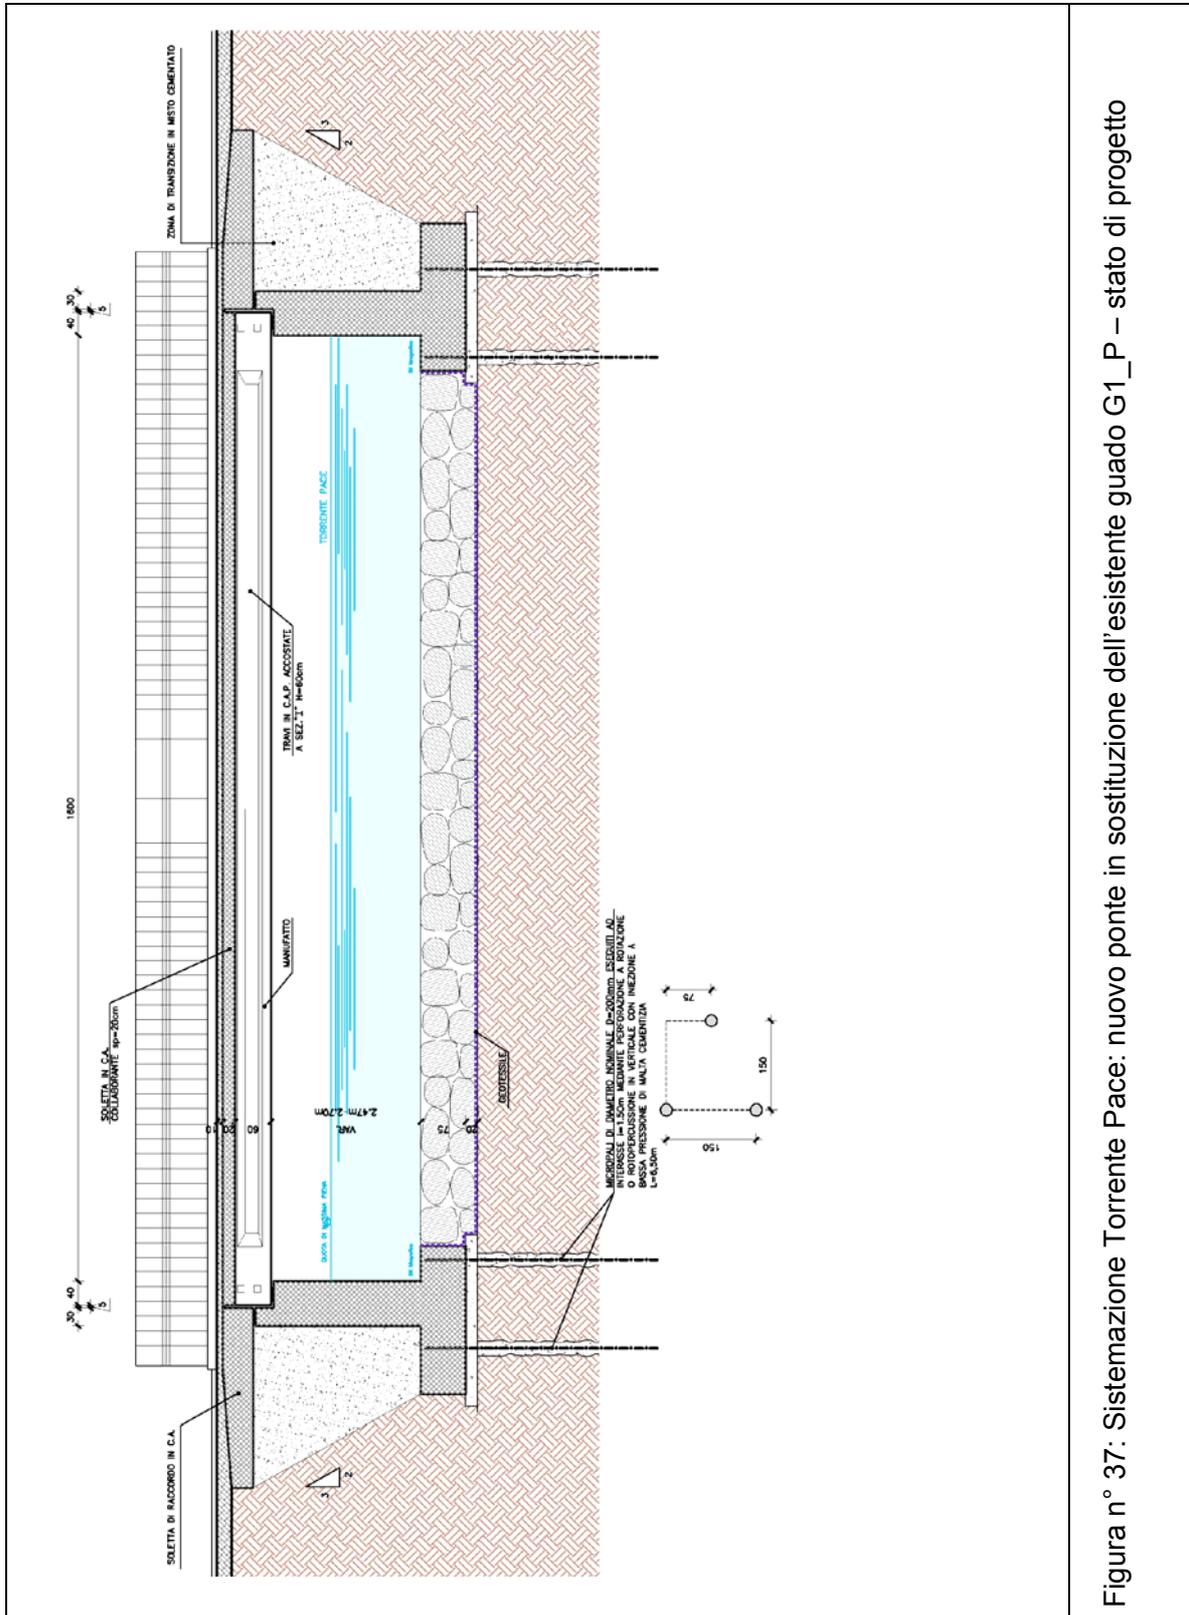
Sistemazione Torrente Pace: nuovo ponte in sostituzione dell'esistente guado G1_P – stato di progetto
